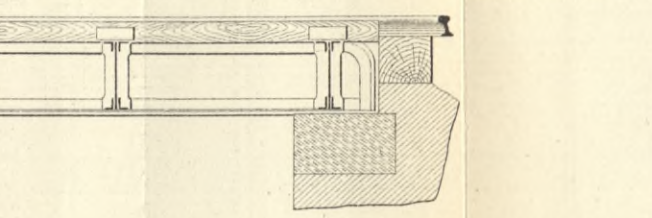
ZAMENSTELLING VAN DE VLOER BOVEN PIJLER V. 1 à 80.
